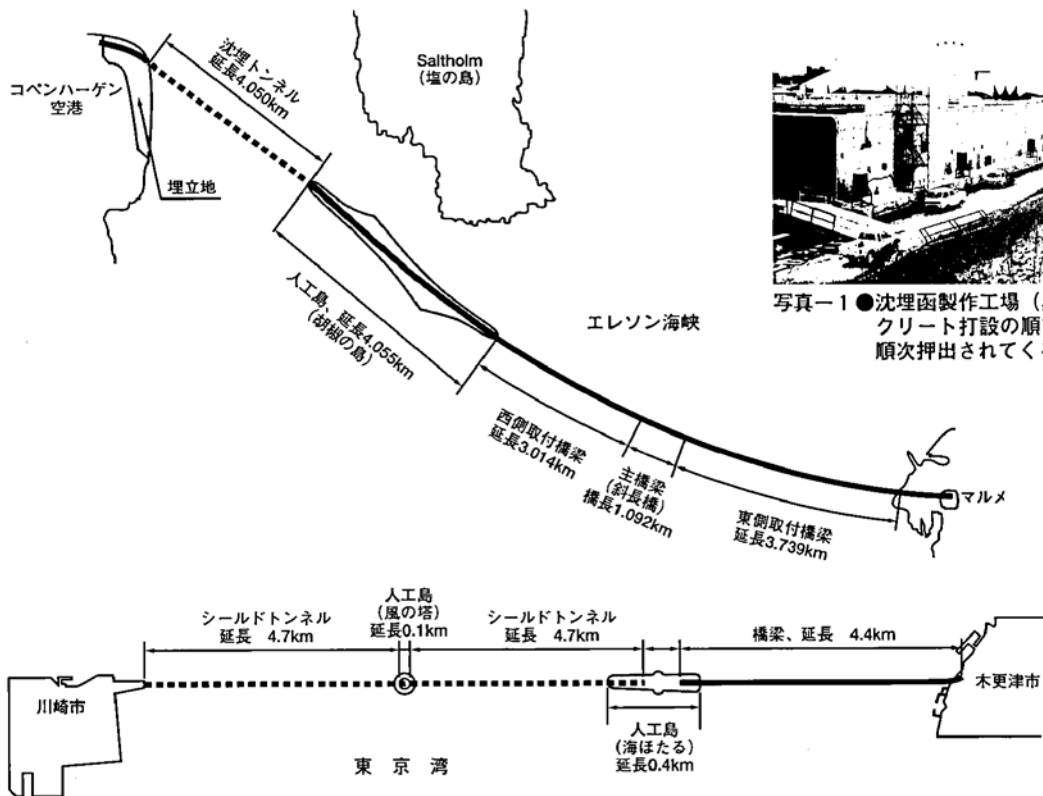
●エレソン海峡横断路平面図 (下段は東京湾横断道路平面図)
